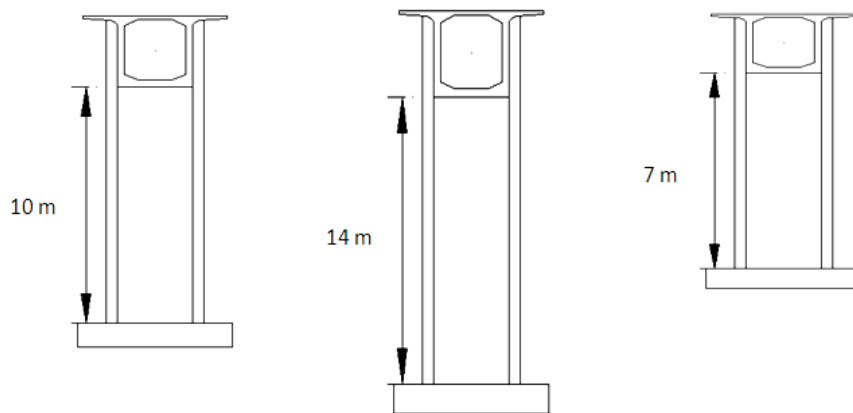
Coupe transversale des piles P₁, P₂, P₃ respectivement
